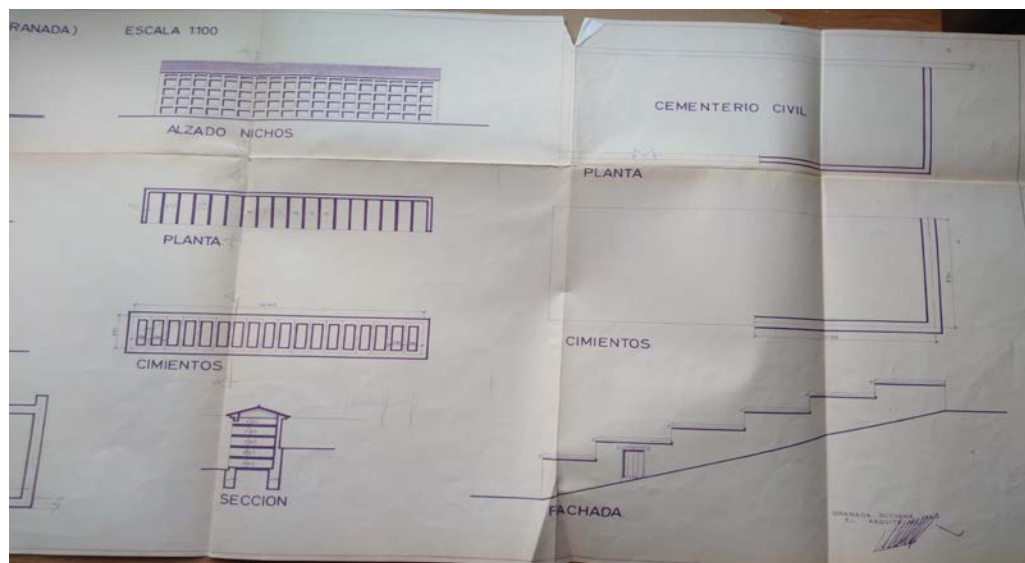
Vista oriental de la fachada del cementerio civil (Reforma del cementerio civil de Ugíjar, 1964)
